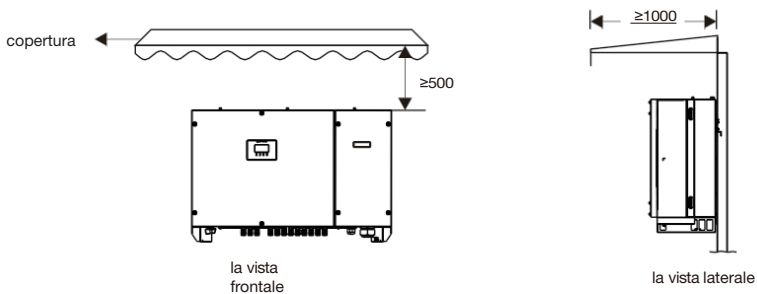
Ambiente di installazione con tenda (unità: mm)
